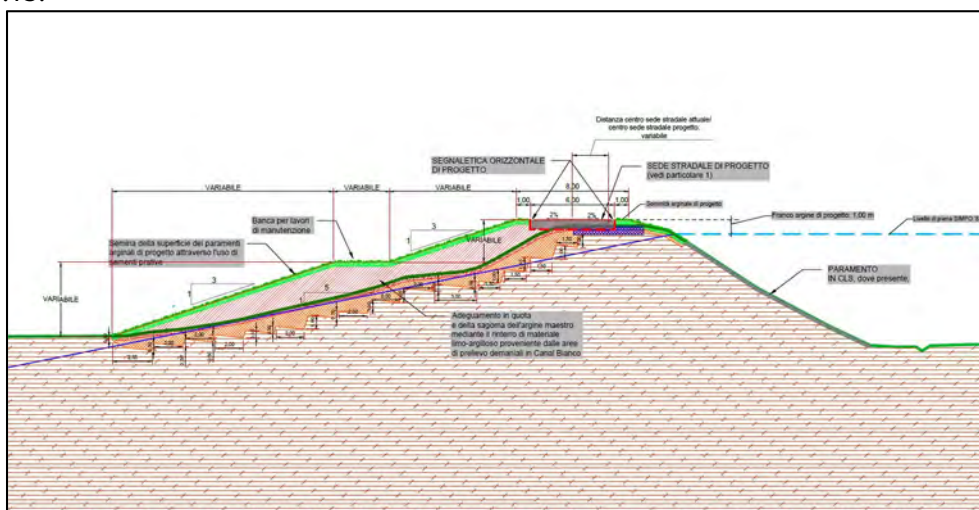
Esempio di dettaglio planimetrico del rilevato arginale di progetto.
